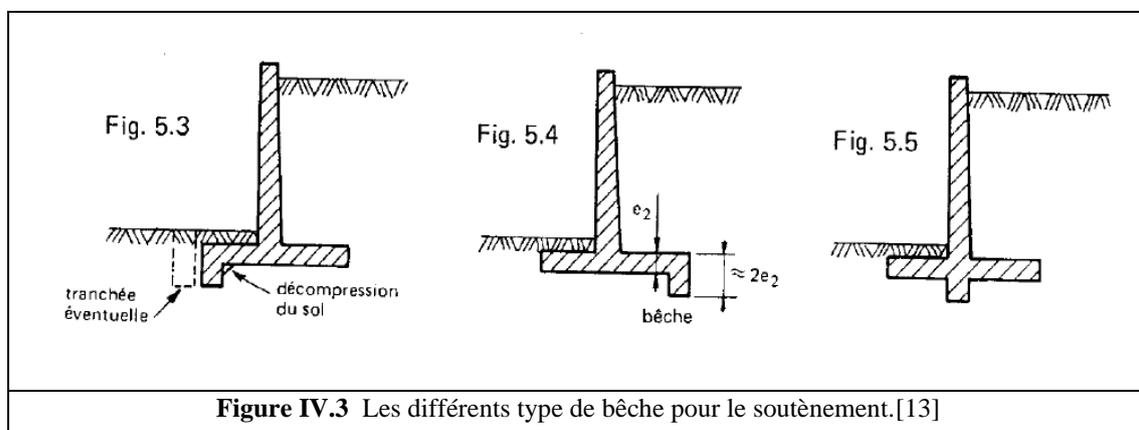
Les différents type de bêche pour le soutènement.[13]
